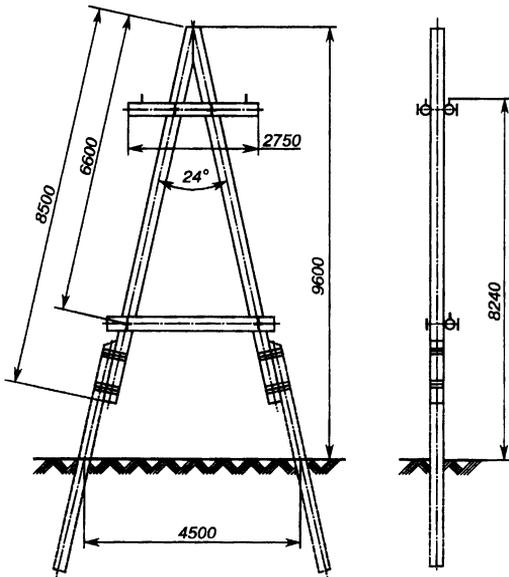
Ригельные крепления анкерных опор ВЛ 6–10 кВ.
